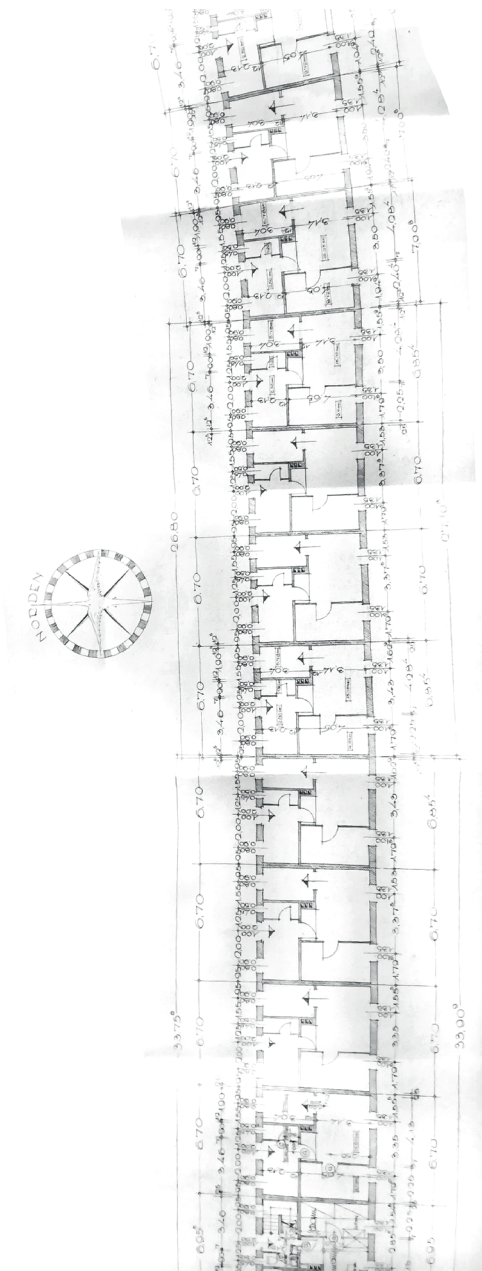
Büro Herbert Rimpl, Auerlingstraße 22-44, Grundriss Erdgeschoss
